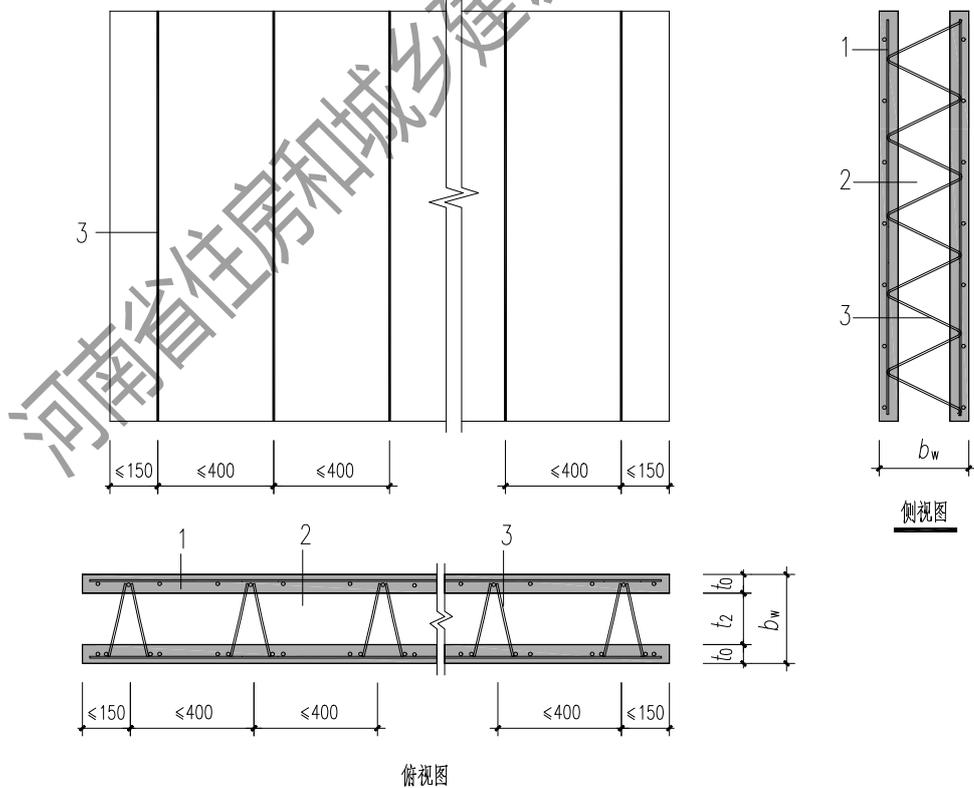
预制双面叠合墙板中钢筋桁架的布置要求
